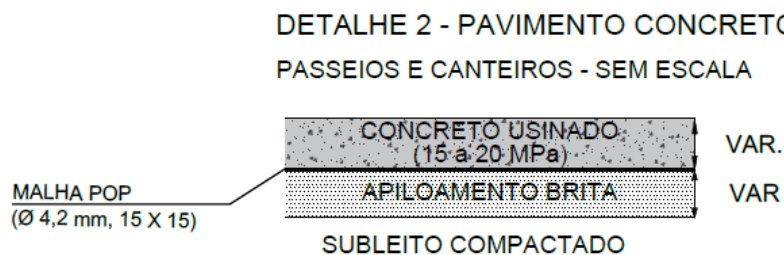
Pavimento Concreto Usinado Calçada de 5 cm
